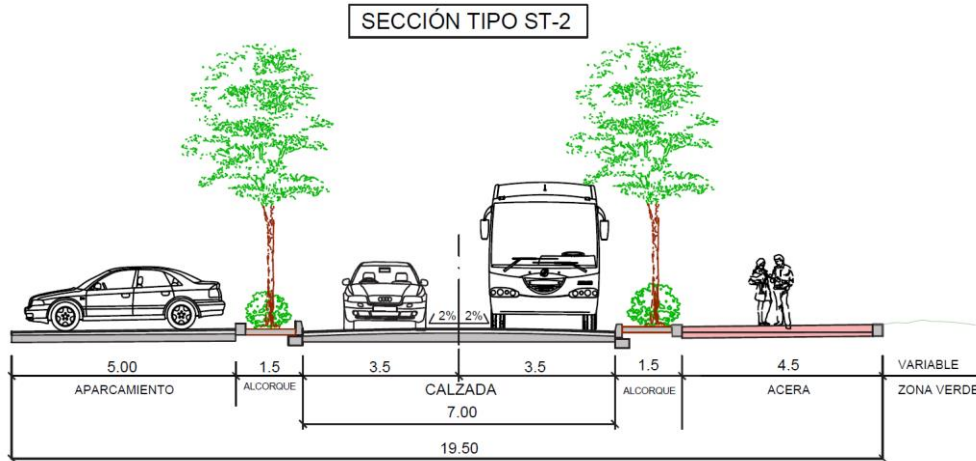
Sección Tipo ST-2 del campus de la UA. Elaboración propia.
